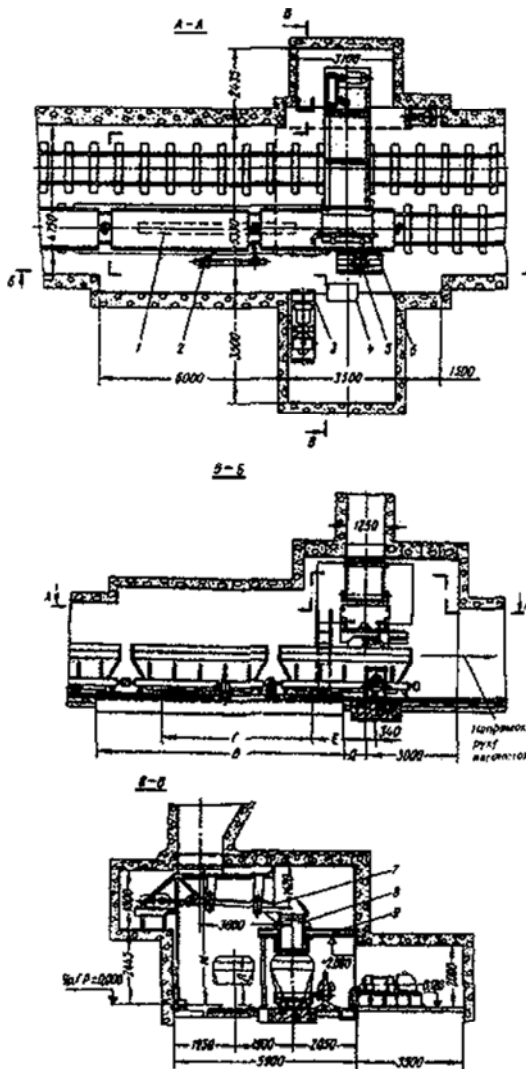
Автоматизований навантажувальний пункт ОПП для вагонеток з відкидними днищами типу ВД:
